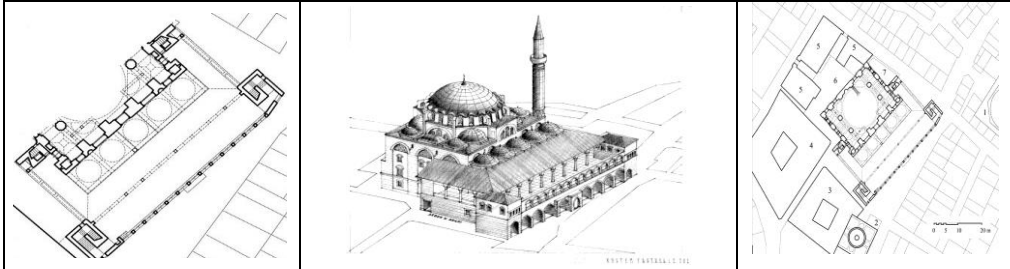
مسقط أفقي وقطاع لمسجد محمود باشا بإستانبول يوضح سقيفته. (عن: جودوين بتصرف).
